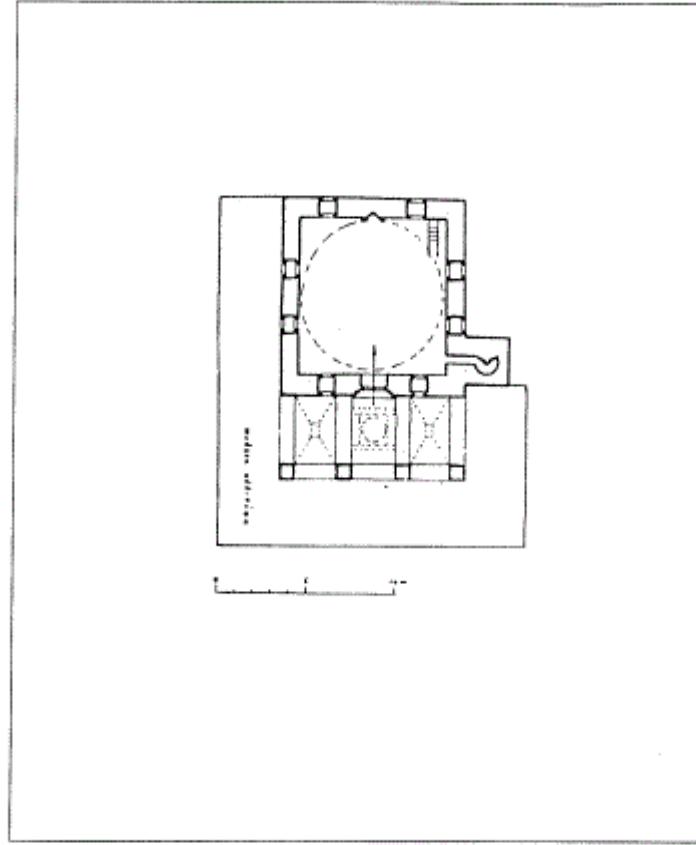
مسقط أفقي للمسجد القديم (اسكى جامع) في اسكى زغرا في بنغازيا
